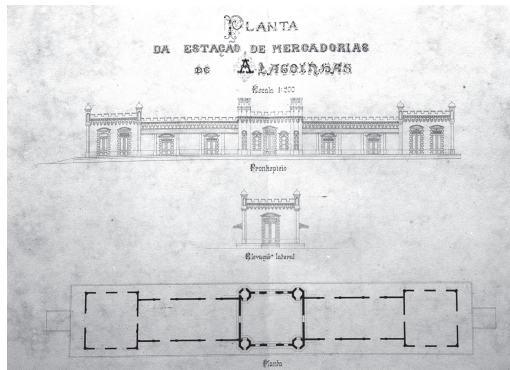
Planta e fachadas da estação de mercadorias da Estação São Francisco. Fonte: Argollo (1900).
